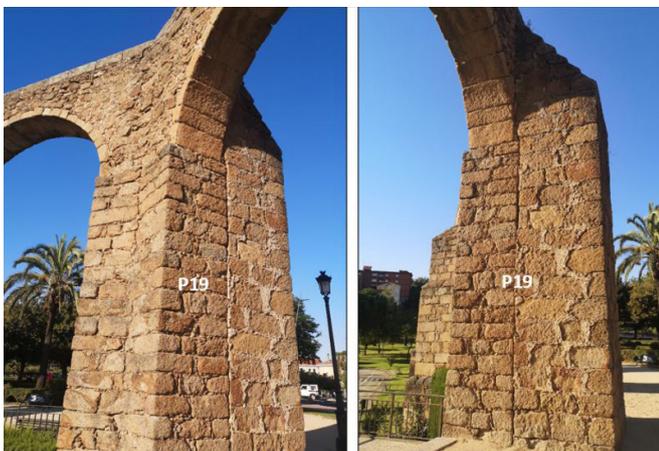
Pilar tipo 2 (P19) visto de frente y en lateral donde se aprecia el contrafuerte de refuerzo hacia la cara exterior del ángulo. Fuente: elaboración propia (2021).
